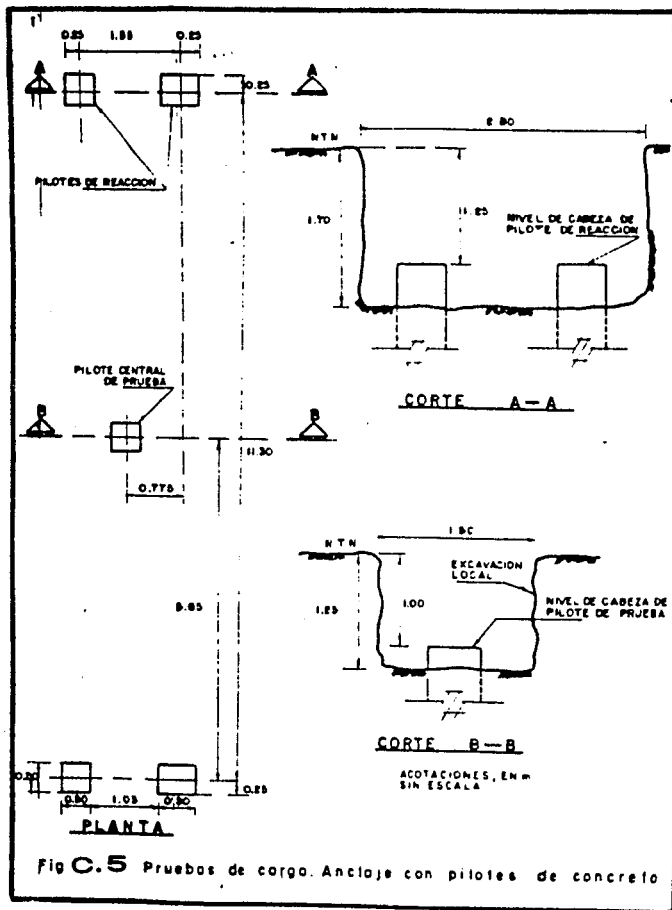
Pruebas de carga. Anclaje con pilotes de concreto
